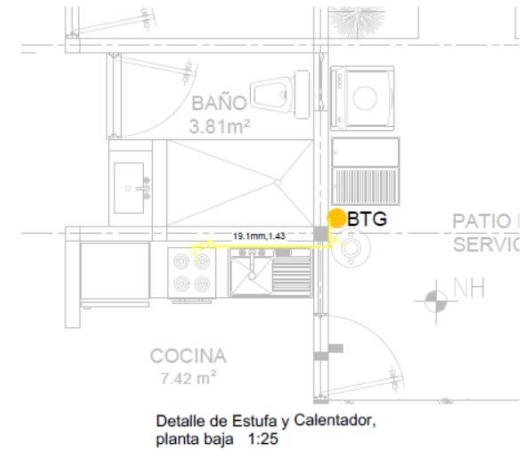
Plano de instalación de gas Plano de elaboración propia, 2017. Plano INS-GA, véase pág. 196.
